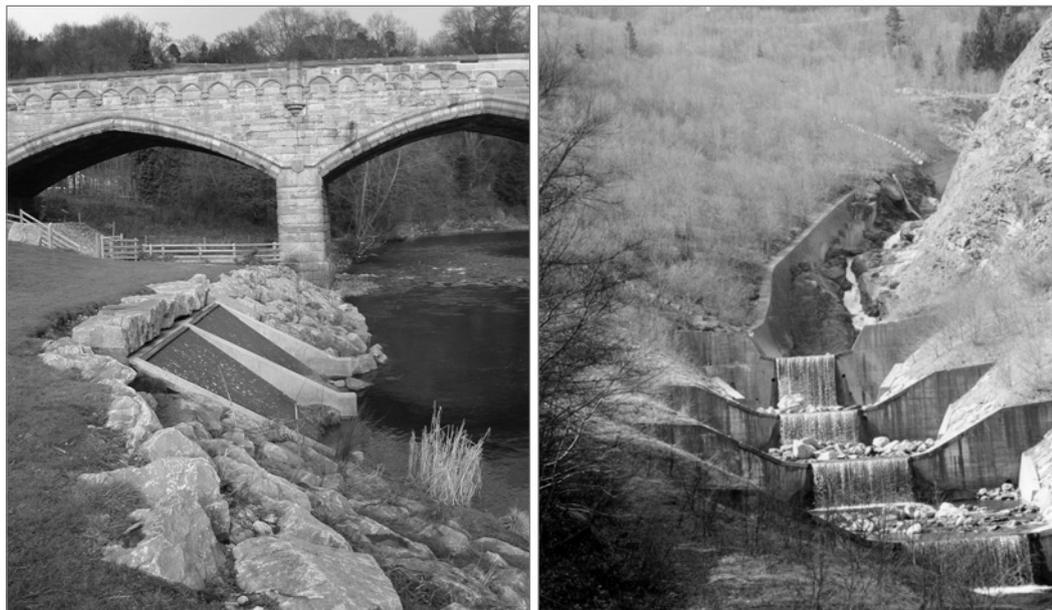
Exemple d'utilisation d'enrochement dans une petite rivière : (à gauche) revêtement en enrochement servant à protéger le déversoir d'un collecteur d'eaux pluviales situé à Richmond (RU) (source: C Rickard); (à droite) régulation d'un torrent à proximité du Felkskanal (Autriche) (source: I Lothérat)
